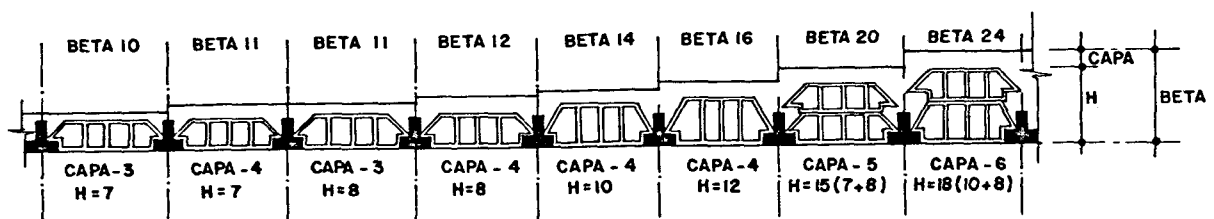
LAJE PRÉ-MOLDADA BETA
